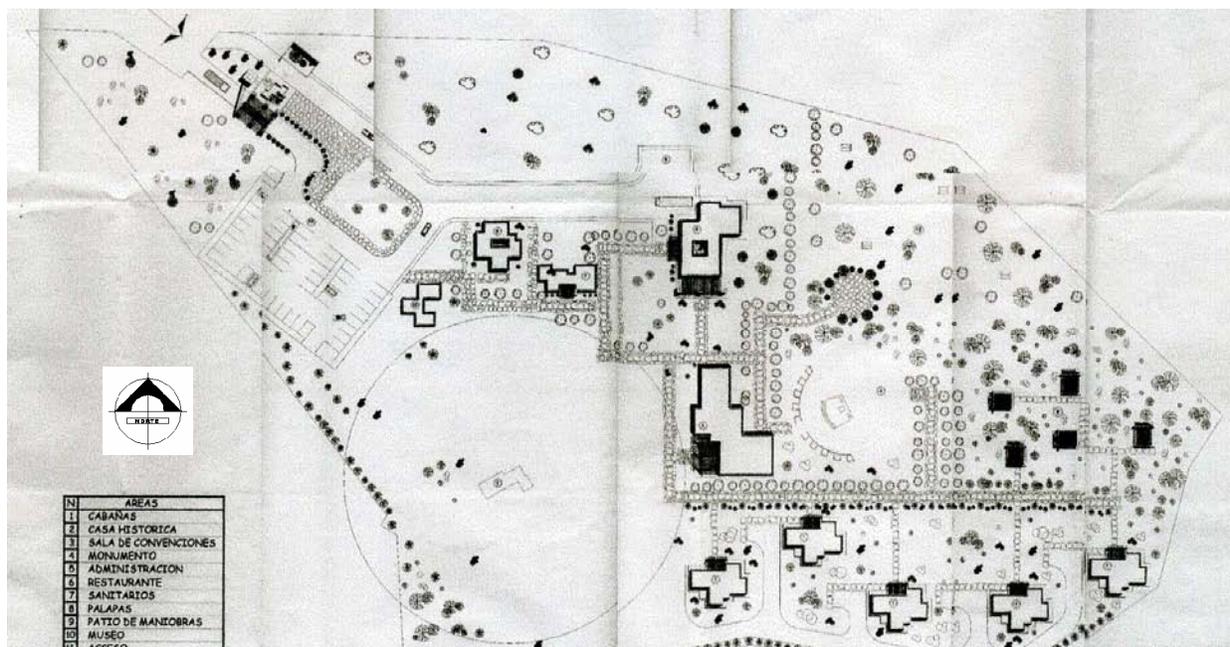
Plano de conjunto del Centro Ecoturístico La Coyotada
